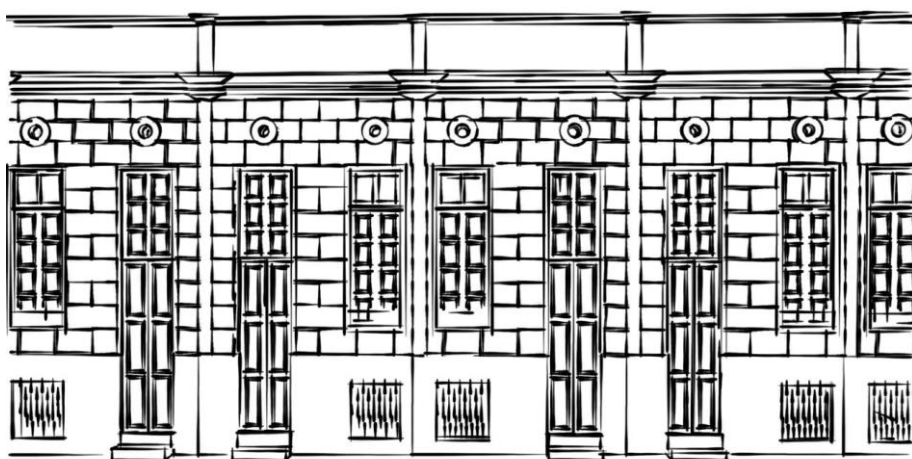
Croqui da fachada das casas na via privativa da Vila Georgette. Fonte: Levantamento por Gabriel Queiroz e edição de imagem da autora.2019.
